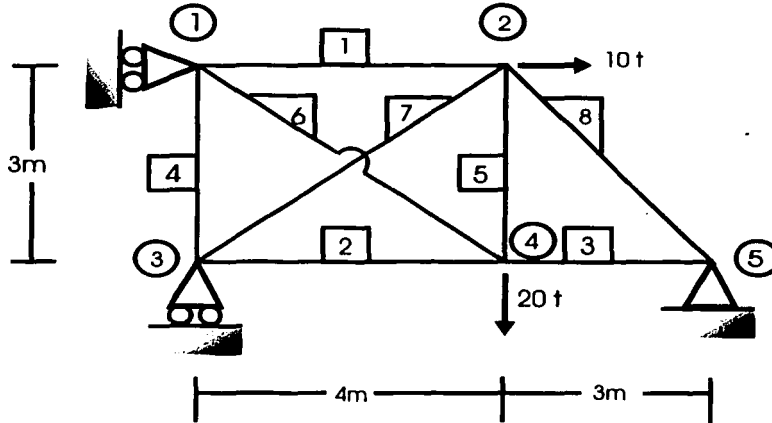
Geometría de la armadura, numeración de elementos y aplicación de cargas.
